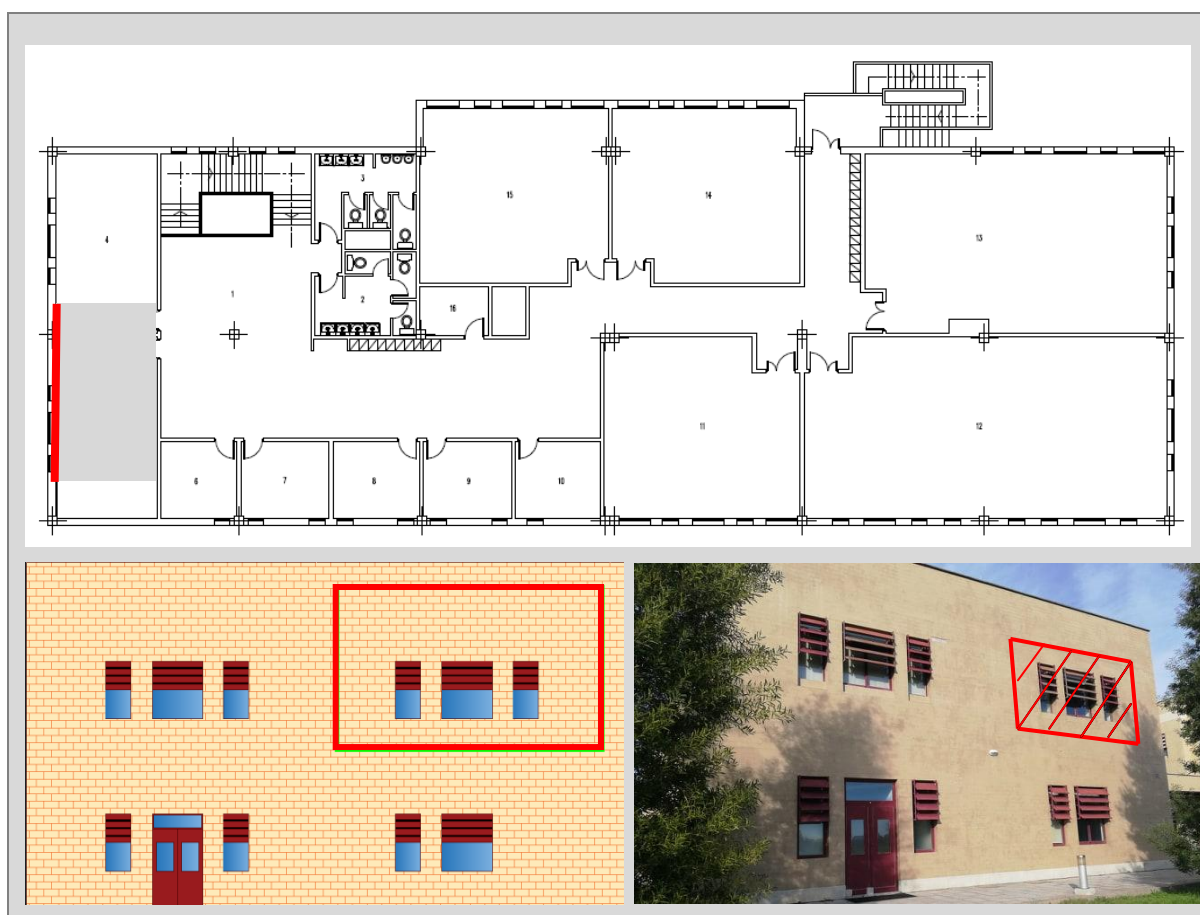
Identificação da parede intervencionada em alçado e em planta Piso 1.
